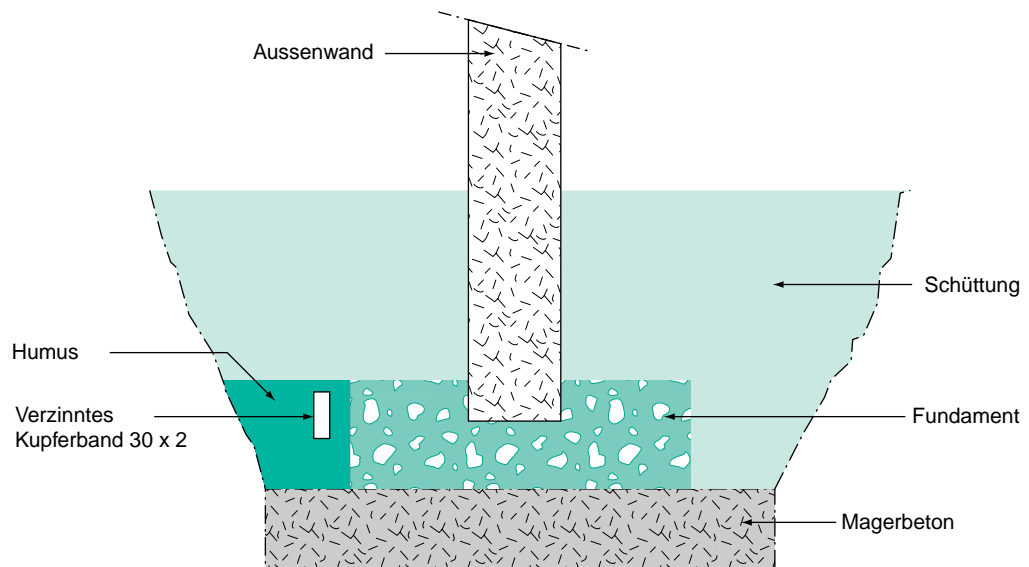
Erder. Ausführung einer Schleife am Grund der Baugrube.
